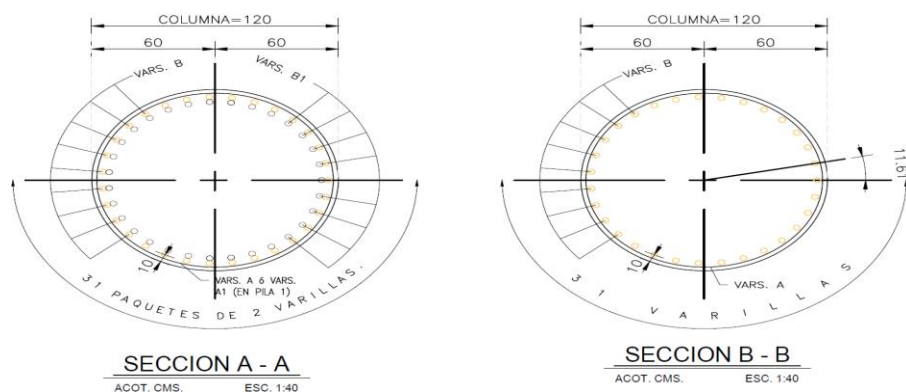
ARI Ingeniería (2023) "Sección transversal del armado de acero estructural para pilas de cimentación"
